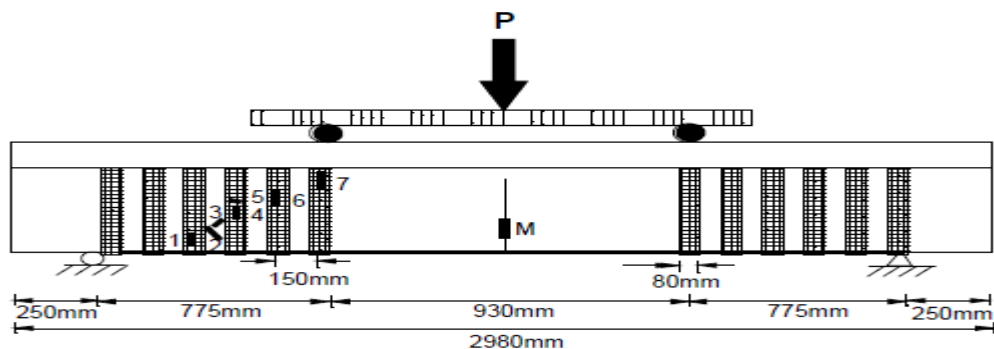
A Exemplarul TT1-1, TS1-1, TS1-11
